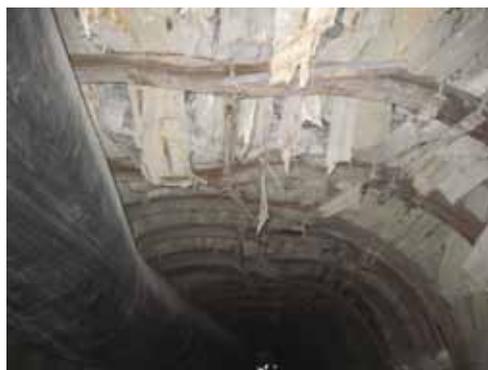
Деформирование крепи вентиляционного штрека №3 за пределами расчетной зоны ПГД
